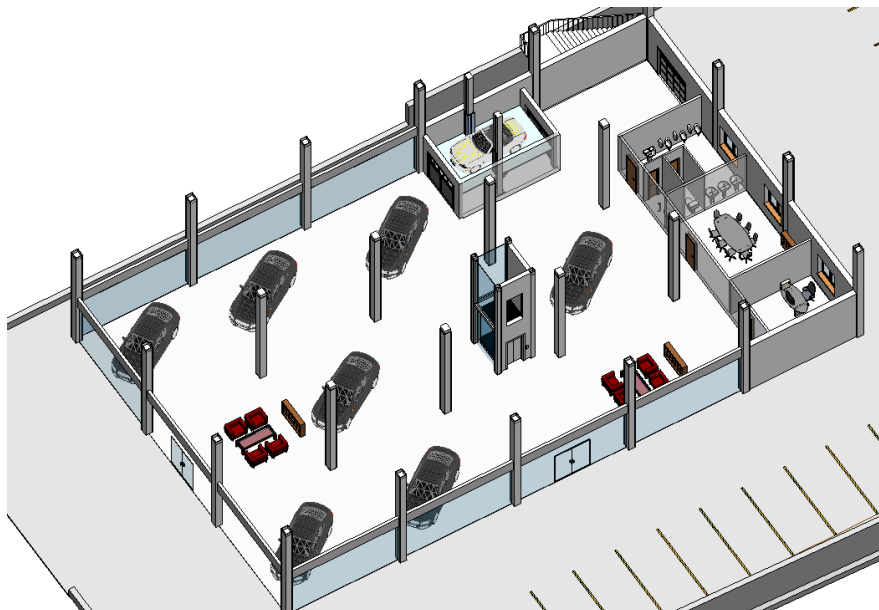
Vista 3D planta baja. Fuente elaboración propia.
